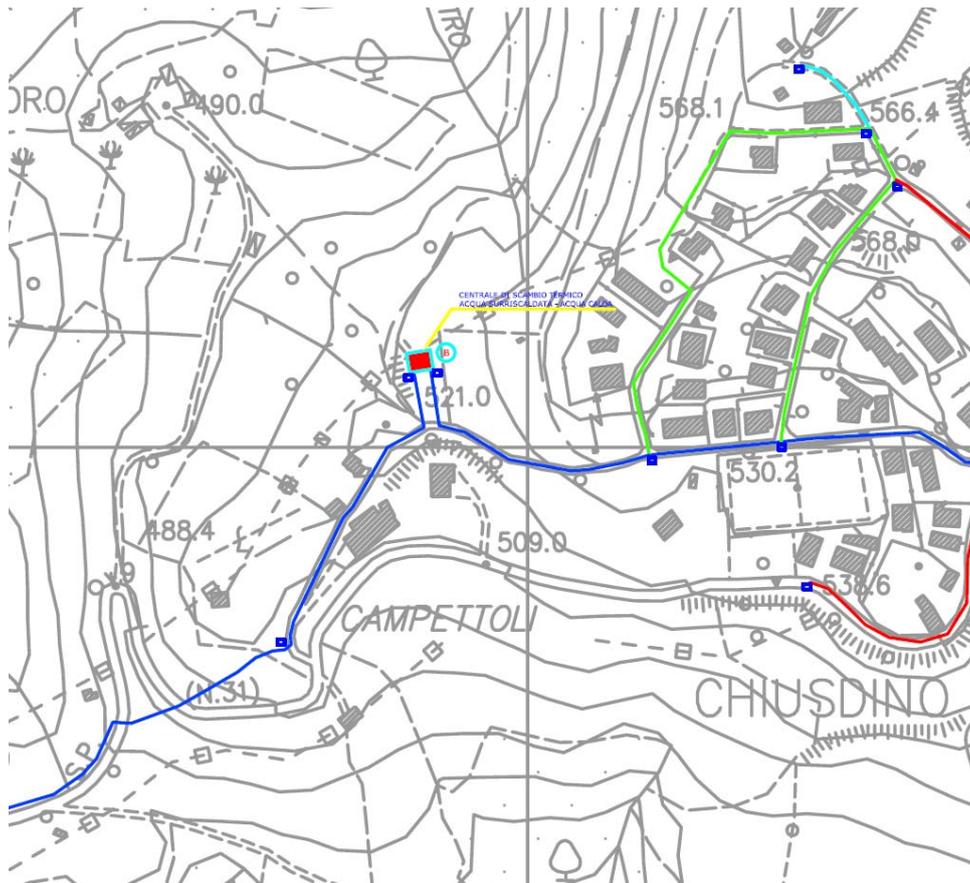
Dettaglio planimetrico rete di teleriscaldamento –acqua surriscaldata/acqua calda
